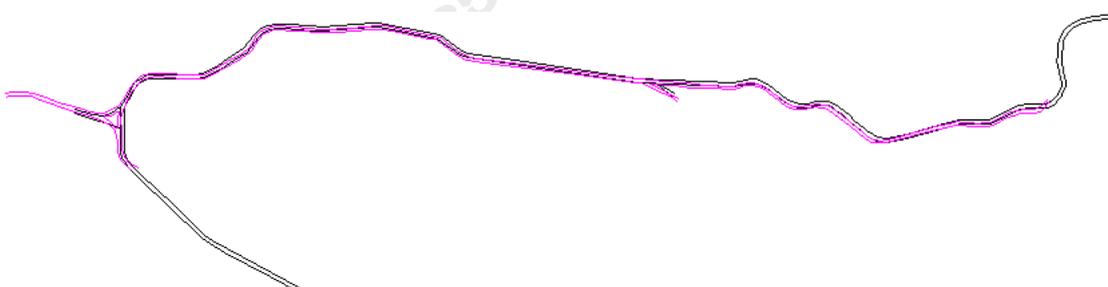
sobreposição entre traçado do projeto Cintra (magenta) e o traçado atual (preto).
